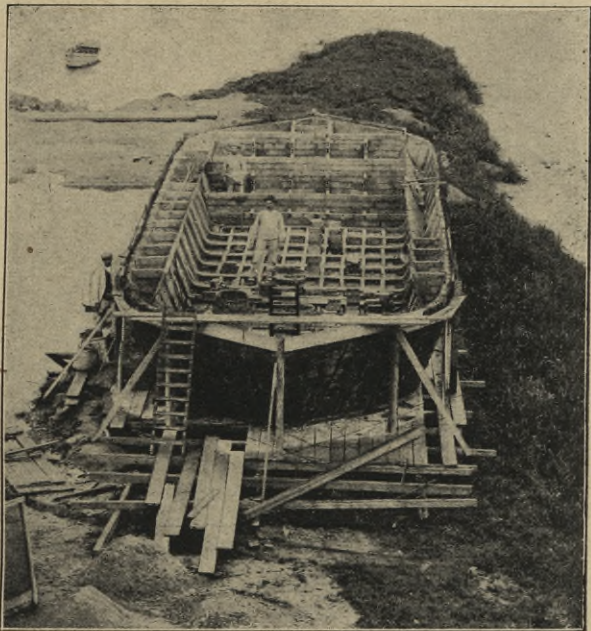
Eisenbetonschiff von 22,36 m Länge, Bauweise Rüdiger.
